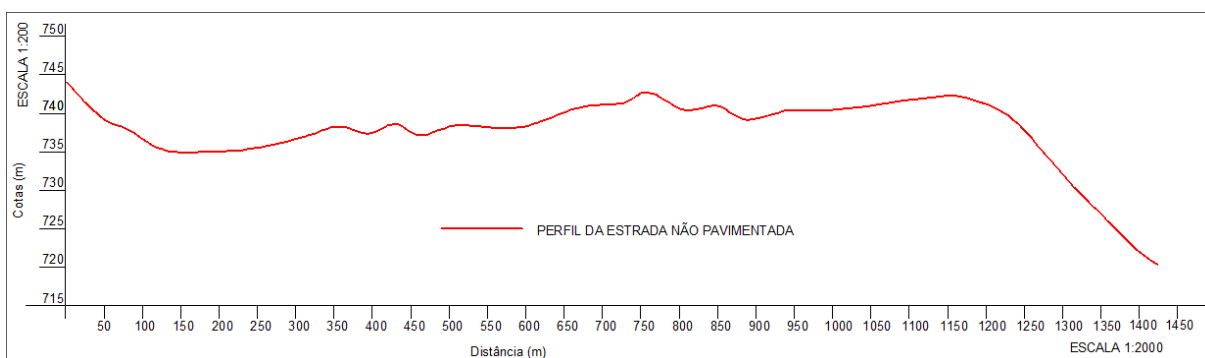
Perfil longitudinal da estrada não pavimentada em estudo
